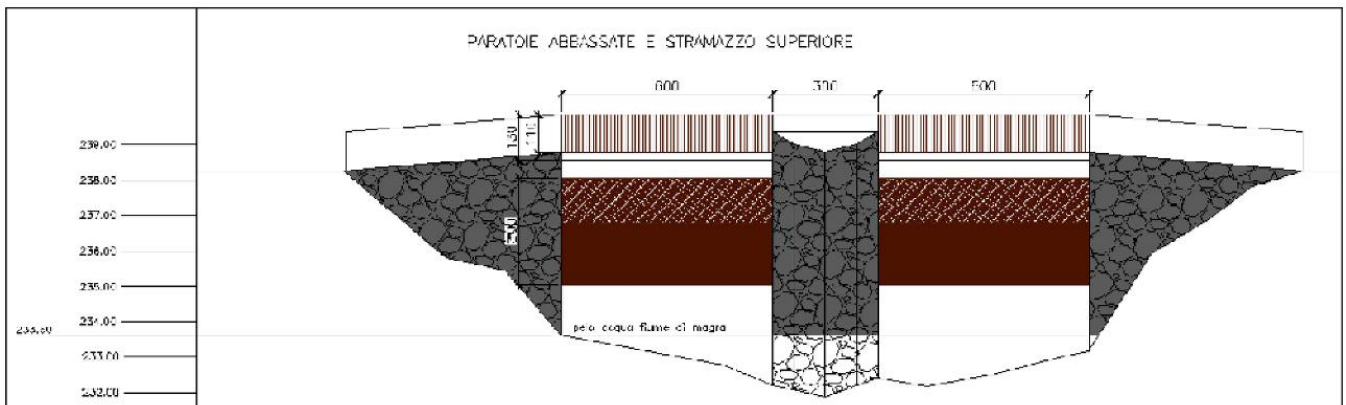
Sezione del ponte di valle (vista da monte)
